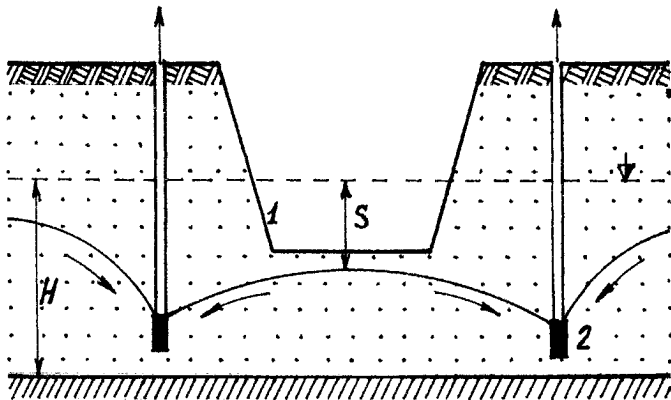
16. Осушення будівельного котлована голкофільтрами:
